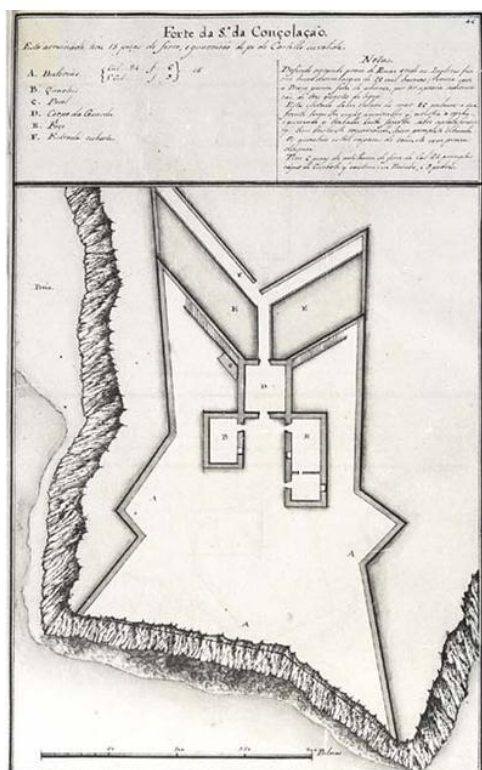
Planta do Forte de Nossa Senhora da Consolação
